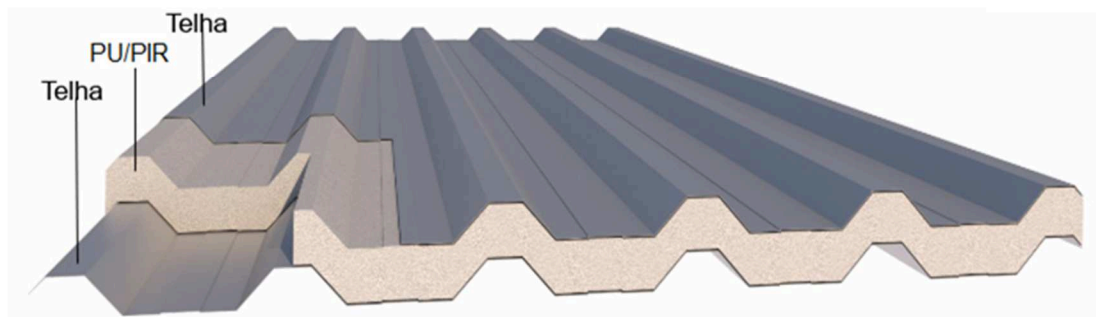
Telha tipo sanduíche em galvalume, com preenchimento de PU/PIR.
